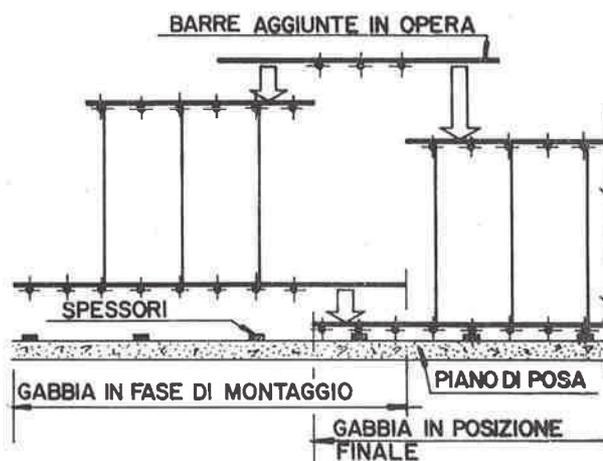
Collegamento per sovrapposizione di gabbie orizzontali
